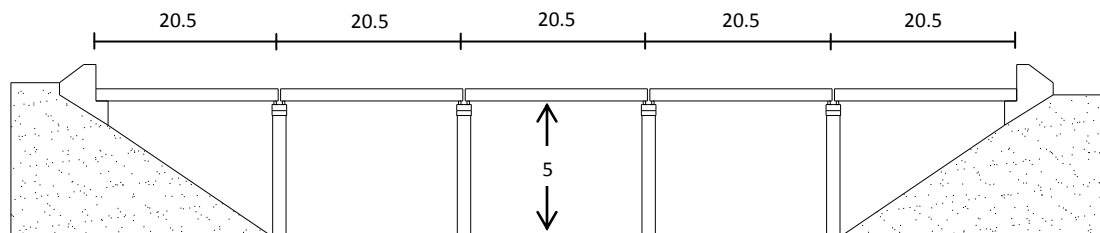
Elevación longitudinal del puente (unidades en m).
